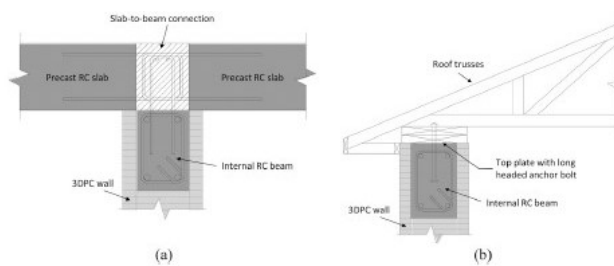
Connessione dei solai alle pareti 3DPC. a) strutture a telaio in calcestruzzo armato prefabbricato, b) strutture in legno (Aghajani Delavar et al. 2024).
